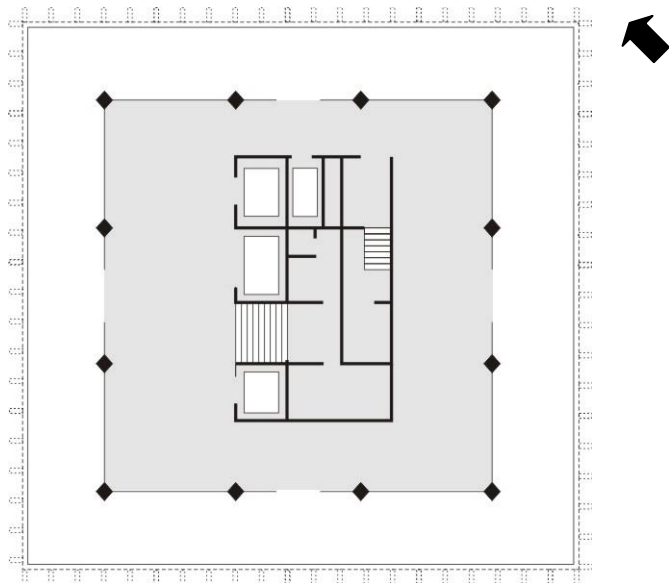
Secretaria Estadual de Educação. Esquema planta do pavimento térreo.
